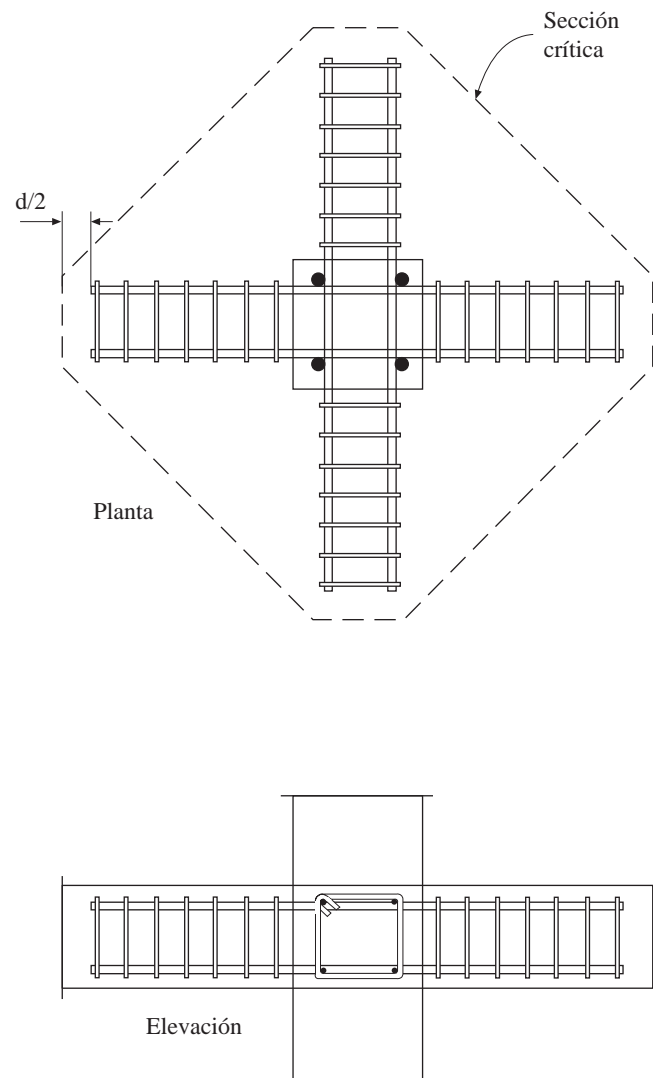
(b) Disposición de estribos de corte, columna interior.
